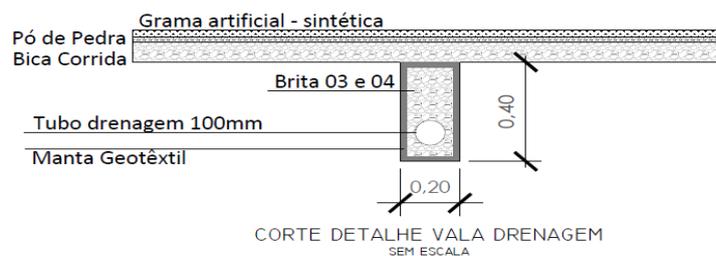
Detalhe de instalação de Drenagem (Fonte: Autor/2024)
